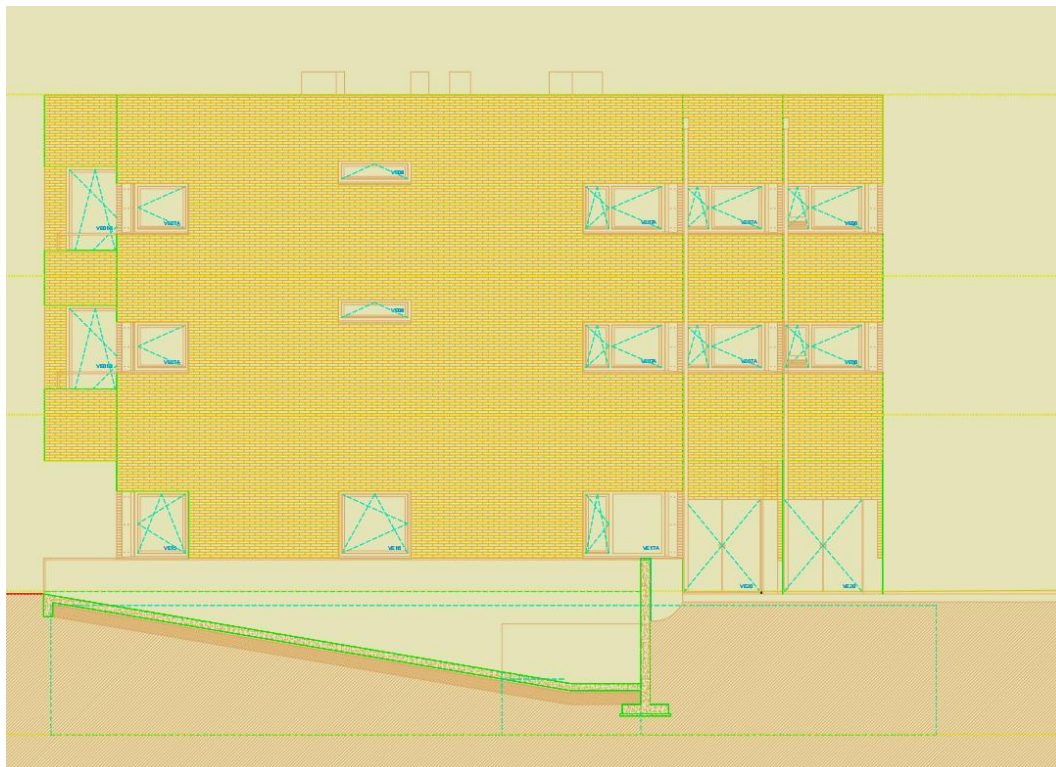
Alçado nascente (FONTE: Ficheiro AutoCad – projeto de arquitetura)
